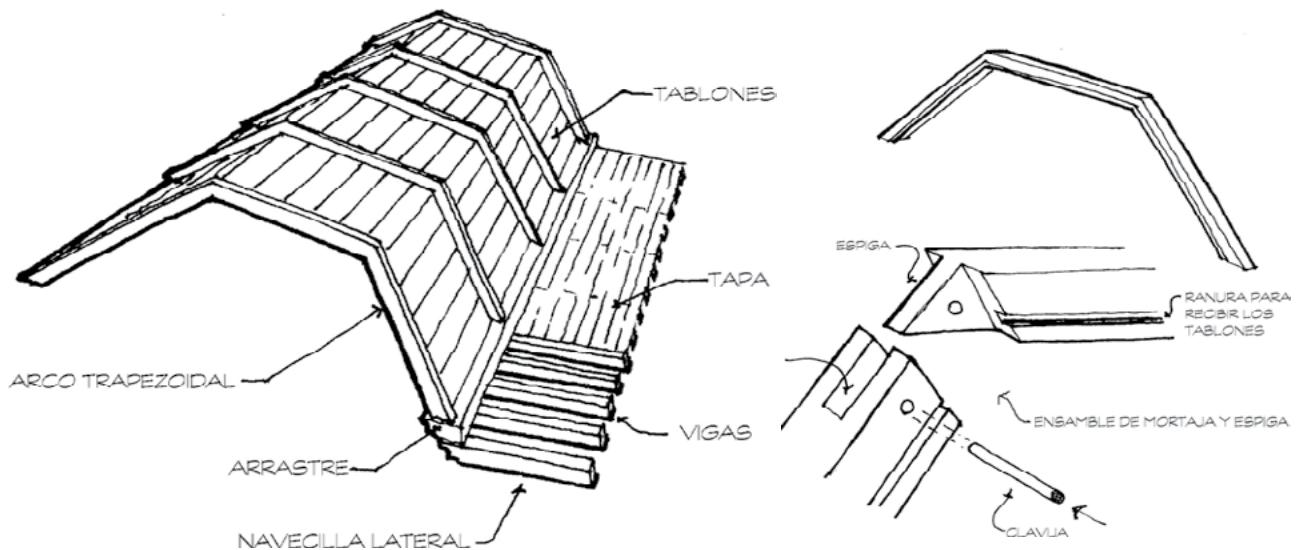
Detalles constructivos del plafón trapezoidal de madera. Esquemas elaborados por Luis Alberto Torres.
